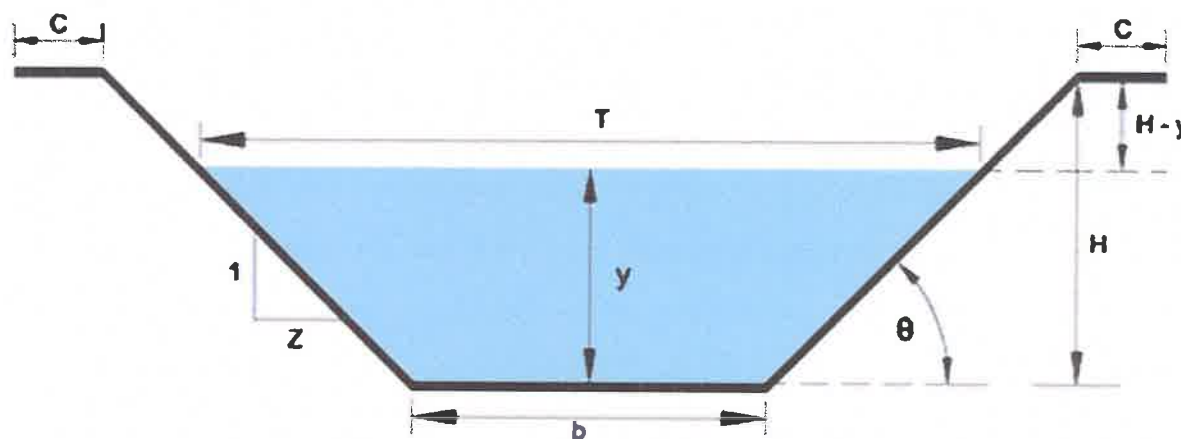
Elementos geométricos de un canal trapezoidal.
